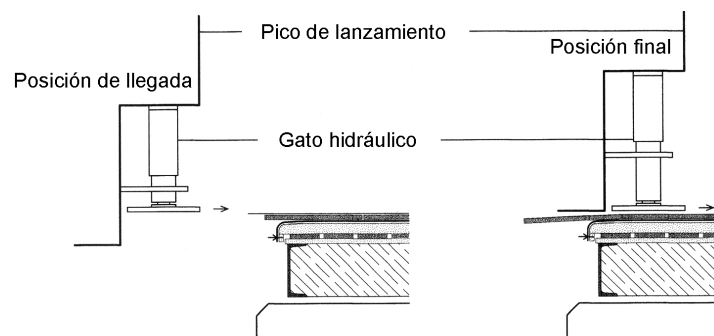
Sistema de elevación del pico de lanzamiento [F23 y elaboración propia].
